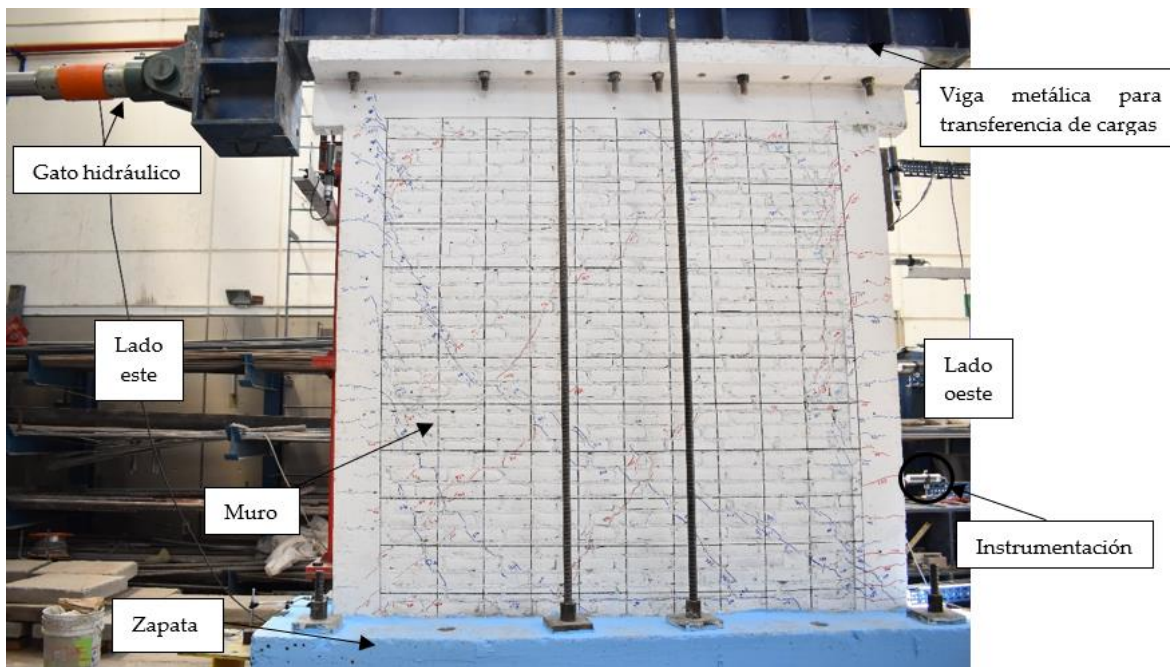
Muro conectado a gato hidráulico durante prueba.
